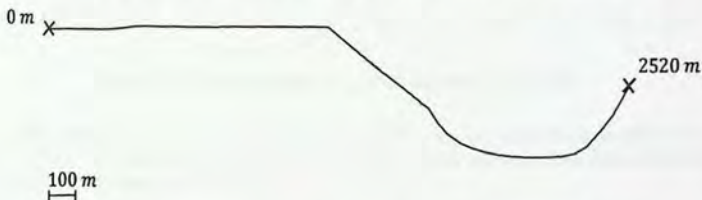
Vista en planta del tramo analizado ubicado en la cercanía del km.15.
